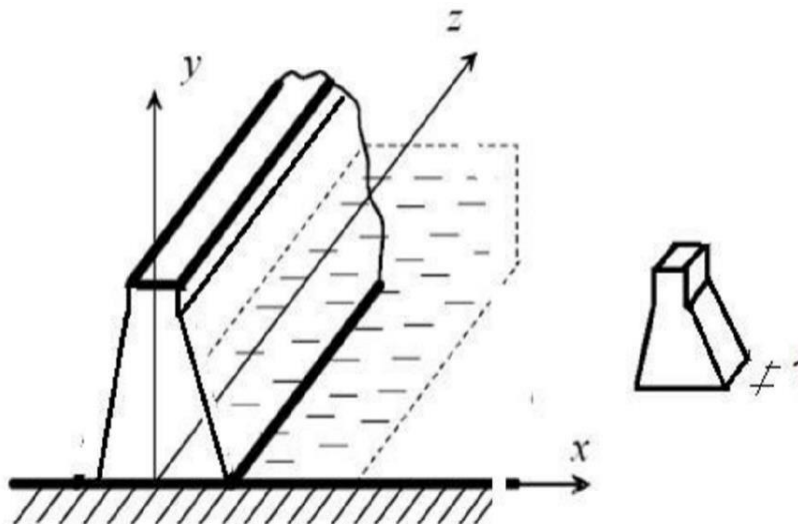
Conditions de déformation plane (exemple d'un barrage en béton).
